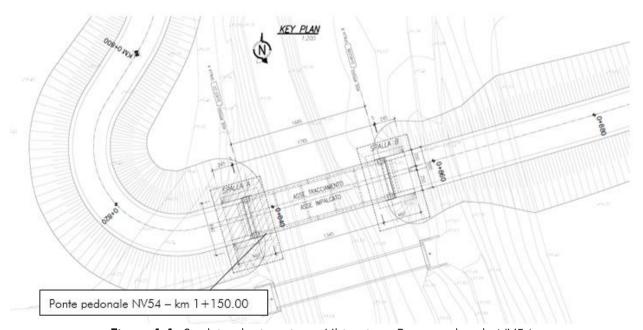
Stralcio planimetrico – Ubicazione Ponte pedonale NV54
